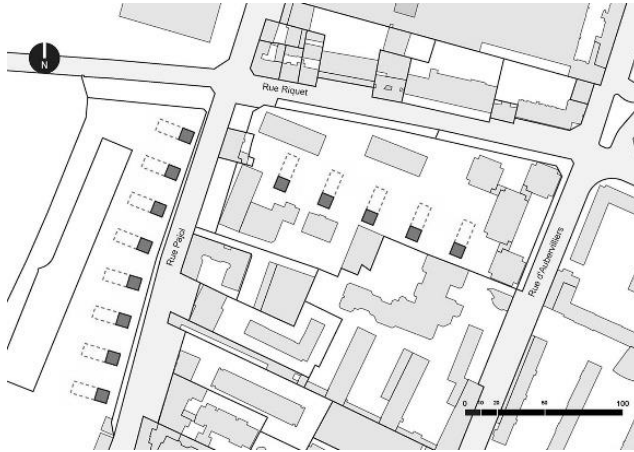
Planta de implantação, adaptado de (SOA, 2007)
